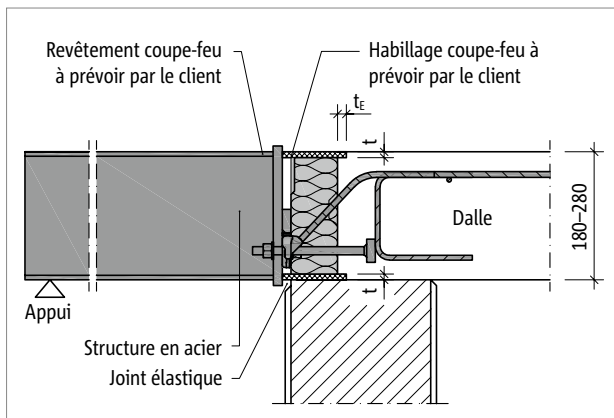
Schöck Isokorb® T type SQ : habillage anti-feu prévu par le client pour l'élément T type SQ, structure en acier munie d'un revêtement de protection incendie ; vue en coupe
